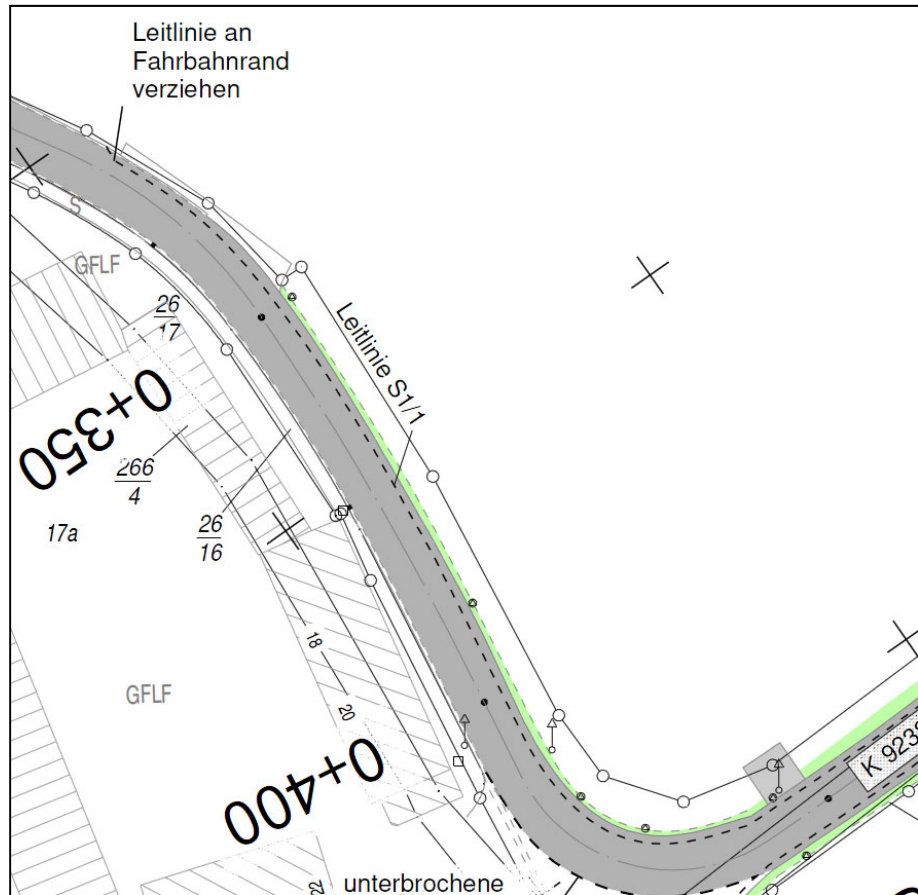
Markierungsplan Knotenpunkt K 9238/K 7271 (LANDRATSAMT BAUTZEN)
